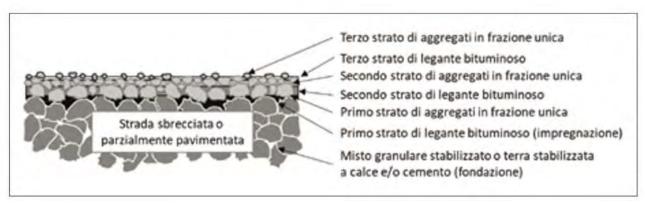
schema tipico di un trattamento con depolverizzazione
